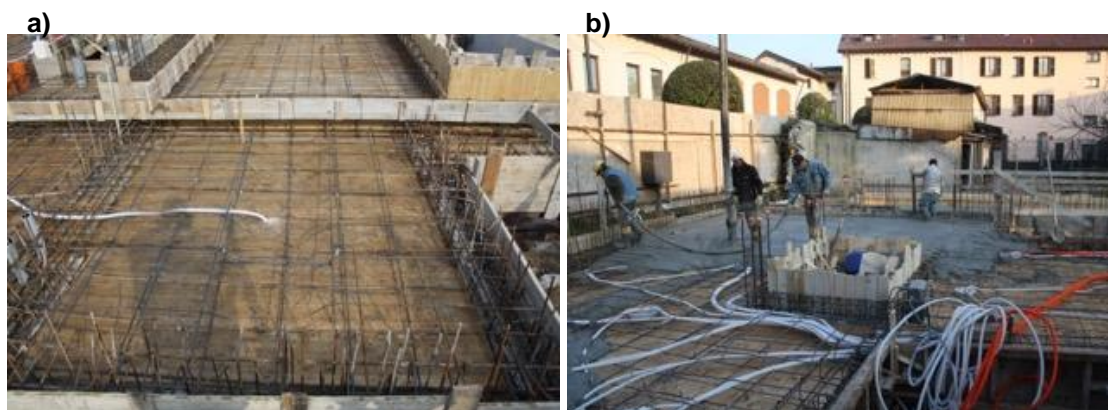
Losa elevada de HRFA, en Erba, Italia.
